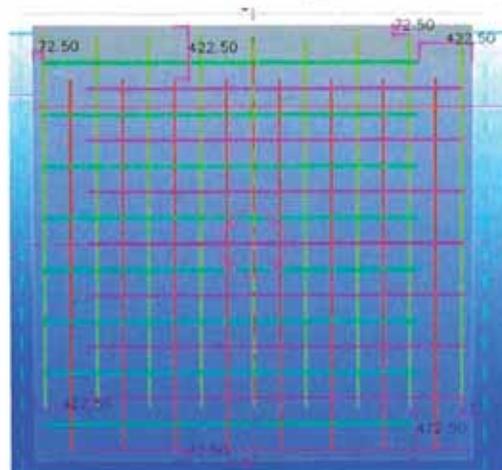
Propuesta de colocación del acero en las zapatas.
